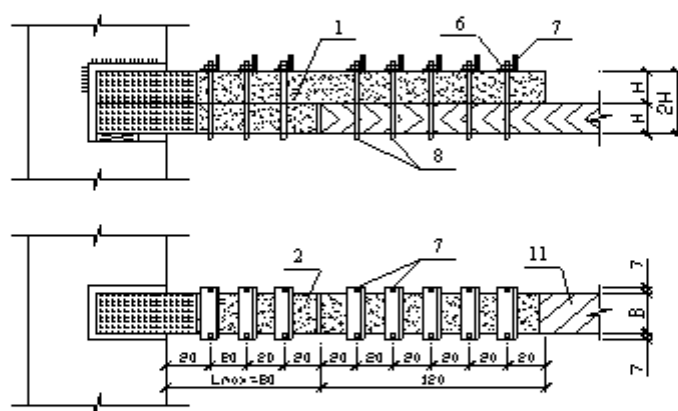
Устройство железобетонной монолитной плиты по металлическим балкам деревянного перекрытия
